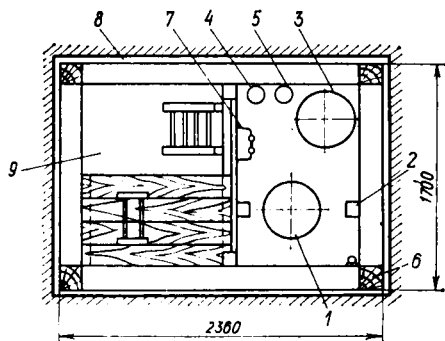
Разрез шурфа площадью поперечного сечения 4 м²:
